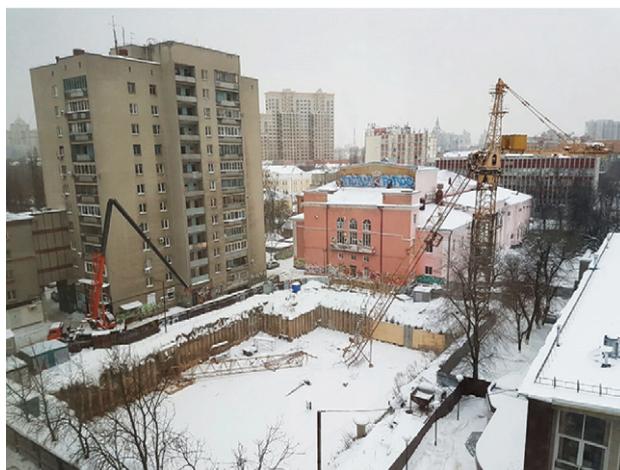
Излом металлоконструкций стрелы автомобильного крана на площадке строительства при наращивании стрелы башенного крана
